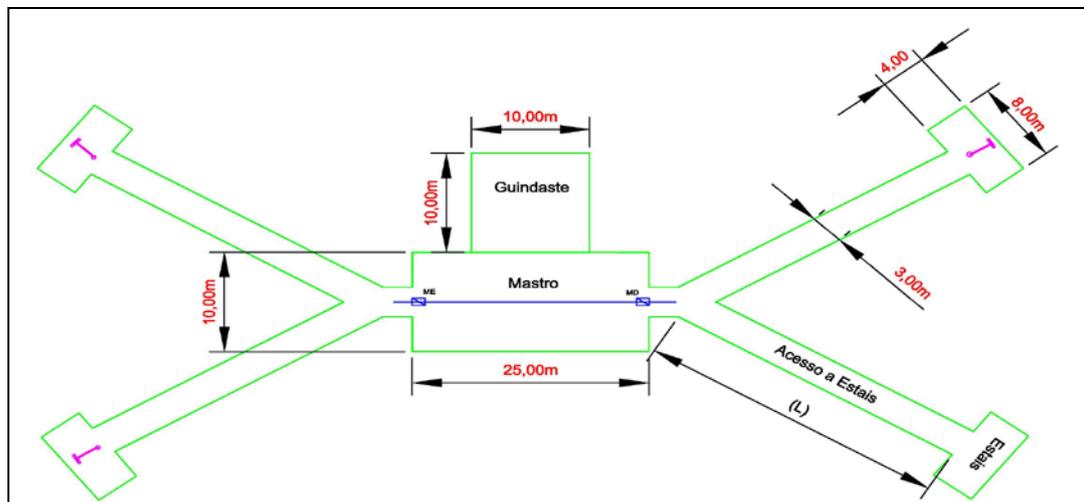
Praça de montagem adicional para torre estaiada.
